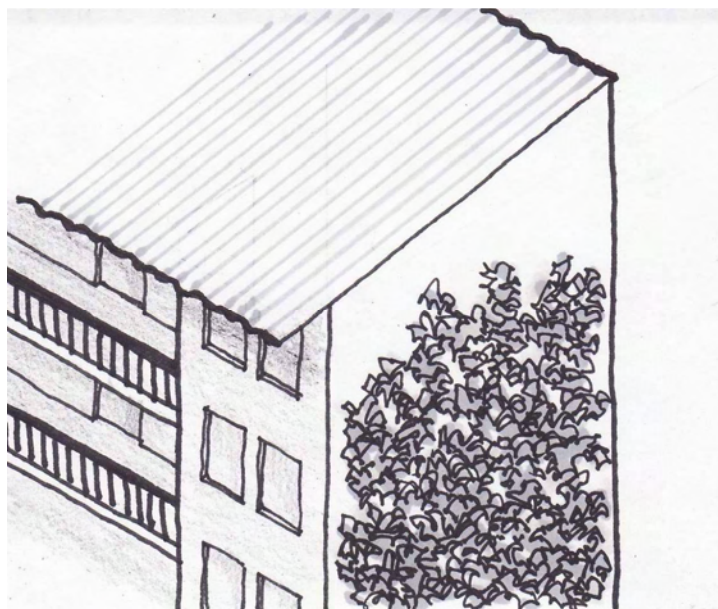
Propuesta de “pared verde” en Condado de Saavedra.
